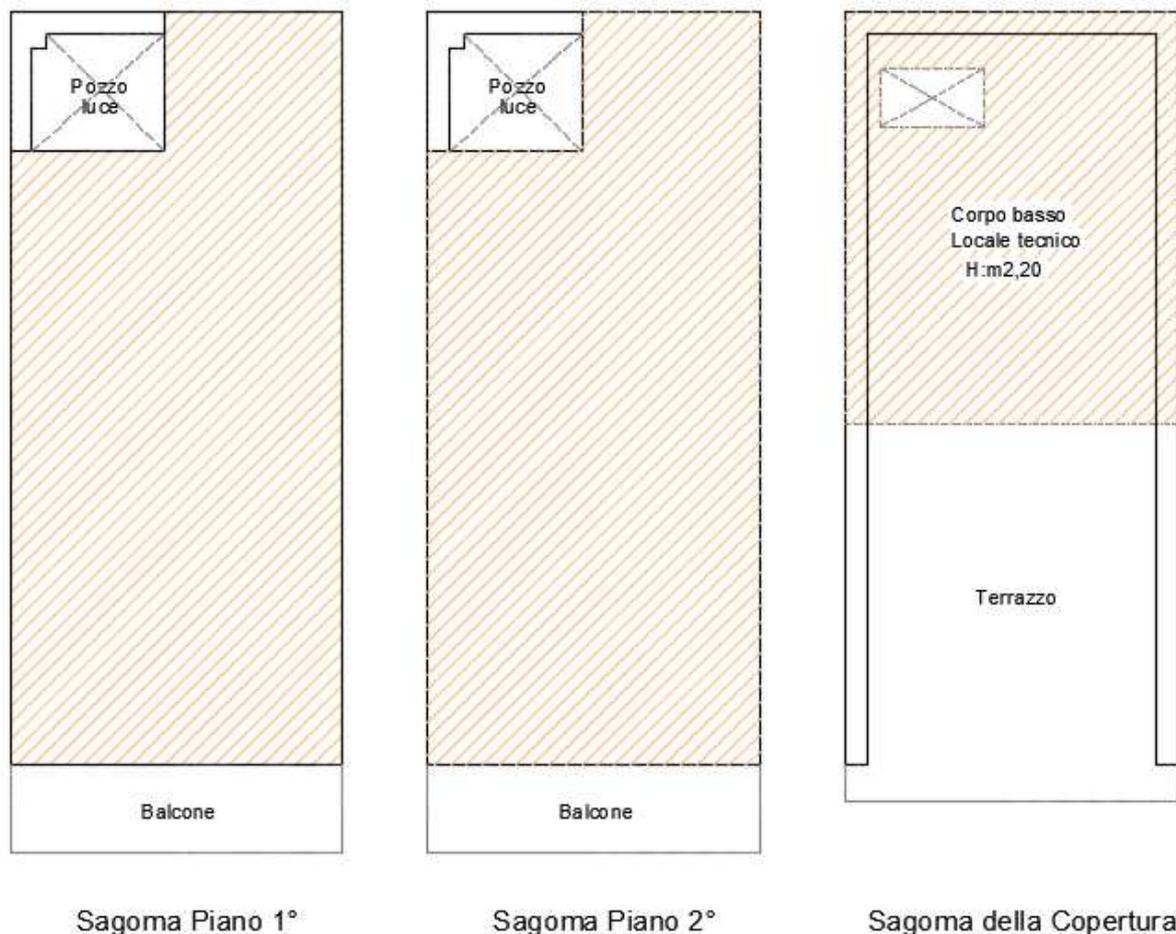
Planimetrie schematiche di piano 1° e 2° e della Copertura
